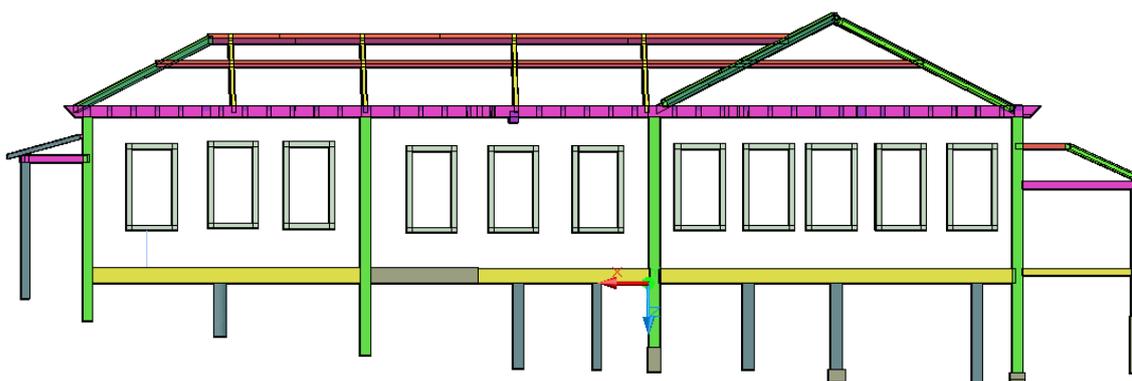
Representação dos elementos em madeira da fachada lateral.
